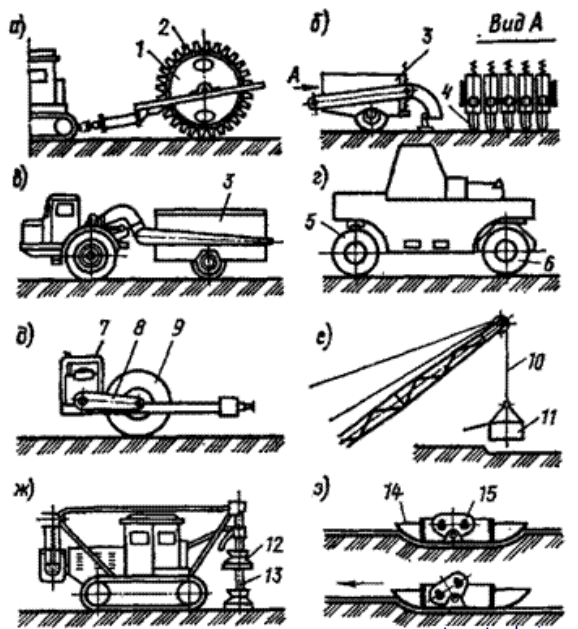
Схемы машин для уплотнения грунтов и дорожных покрытий:
